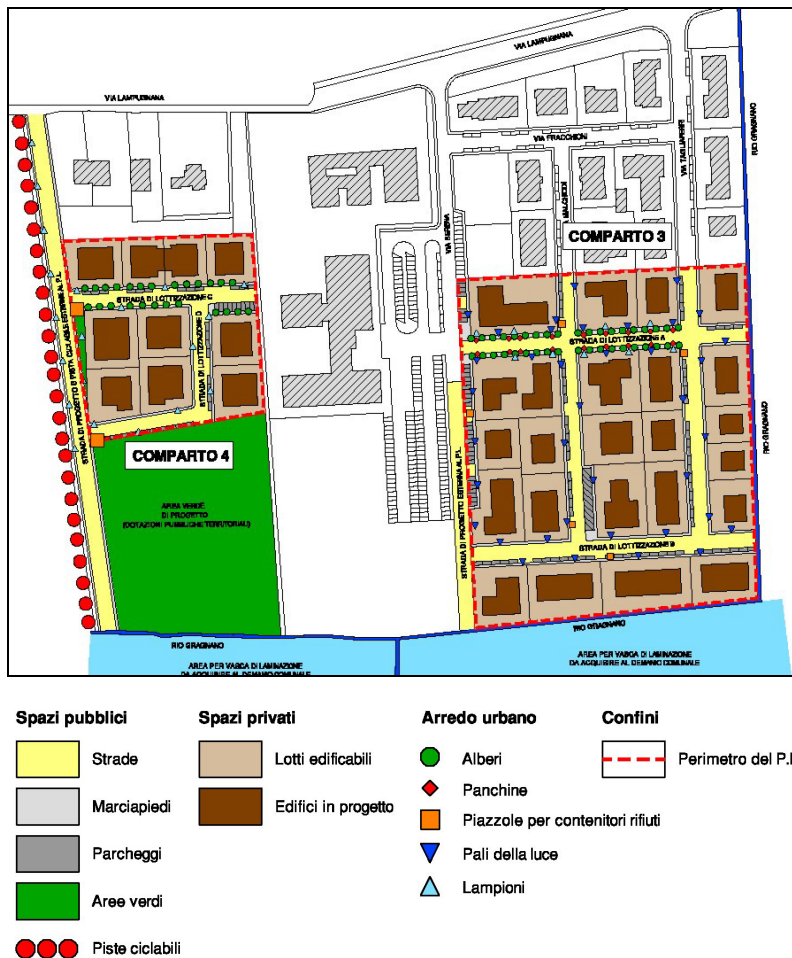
Planimetria di progetto del piano di lottizzazione (comparti 3 e 4)
